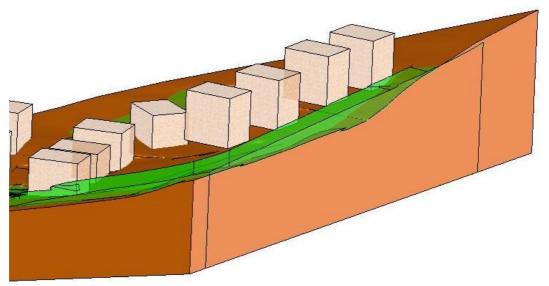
Corte longitudinal da 2ª rua. Terreno original (marrom) e aterro (verde). Escala 1:500.
